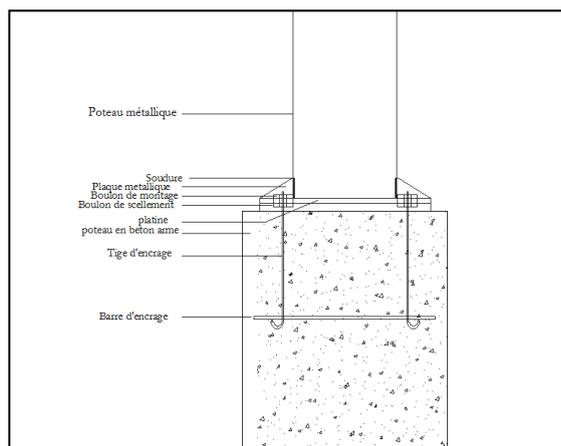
vue sur l'assemblage entre poteaux en béton et en métal
